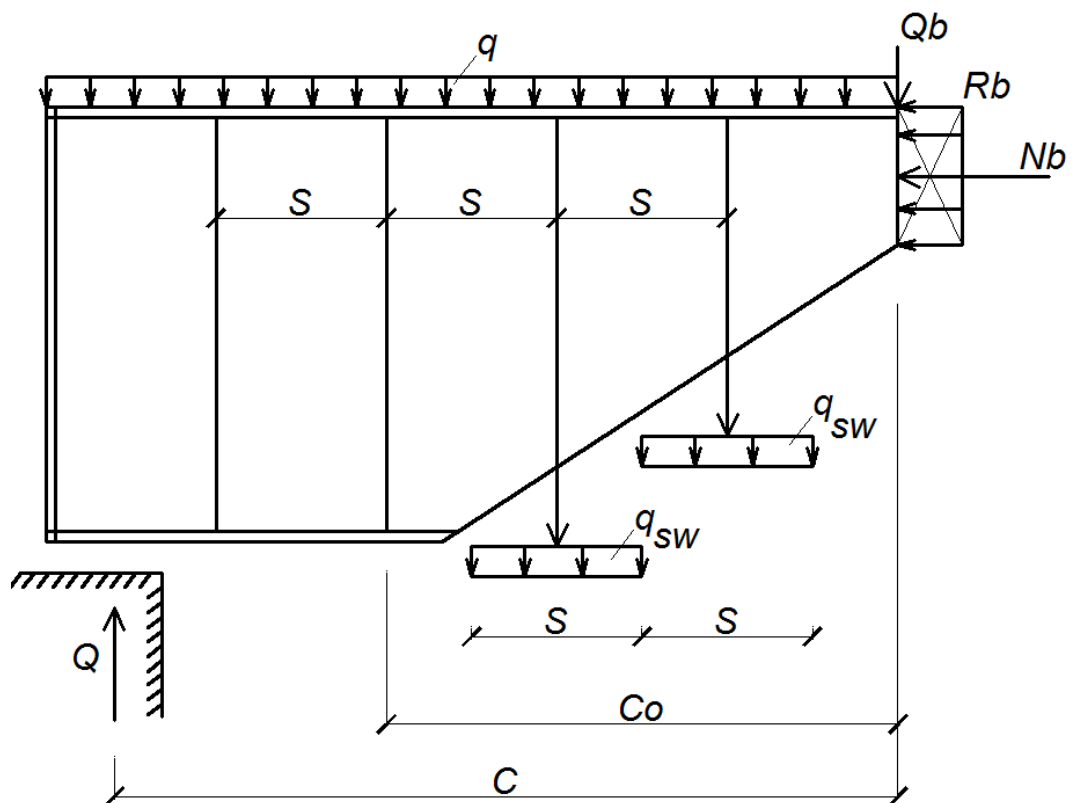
Усилия в поперечных стержнях, принимаемые при расчете по наклонным сечениям
